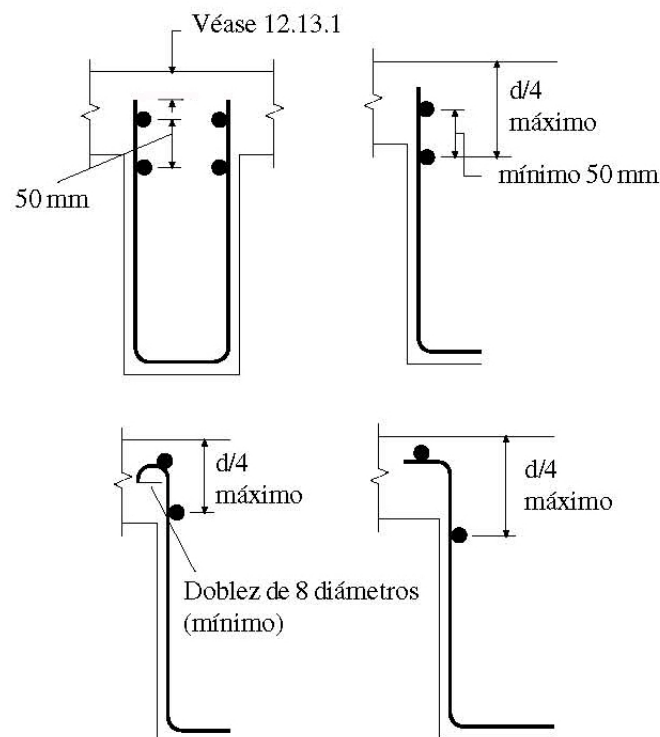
Anclajes de estribos U de refuerzo electrosoldado de alambre liso en la zona de compresión
